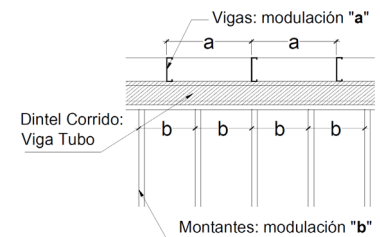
Viga tubo para transmitir las cargas no lineales.
